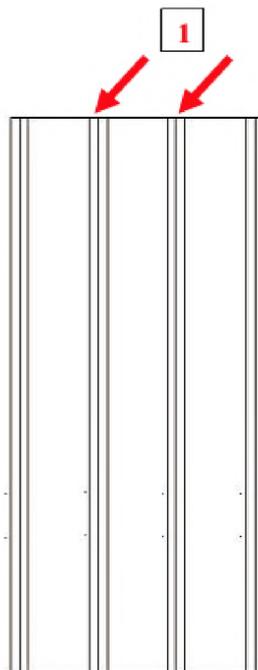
Эскиз верхней части перегородки и зоны отбора образцов
